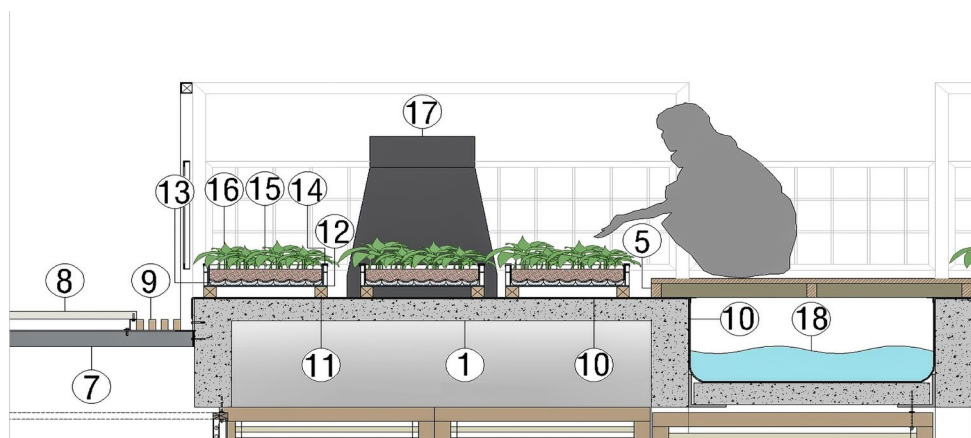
Detalle de cubierta de vivienda propuesta. Fuente: Elaborado por los autores.
